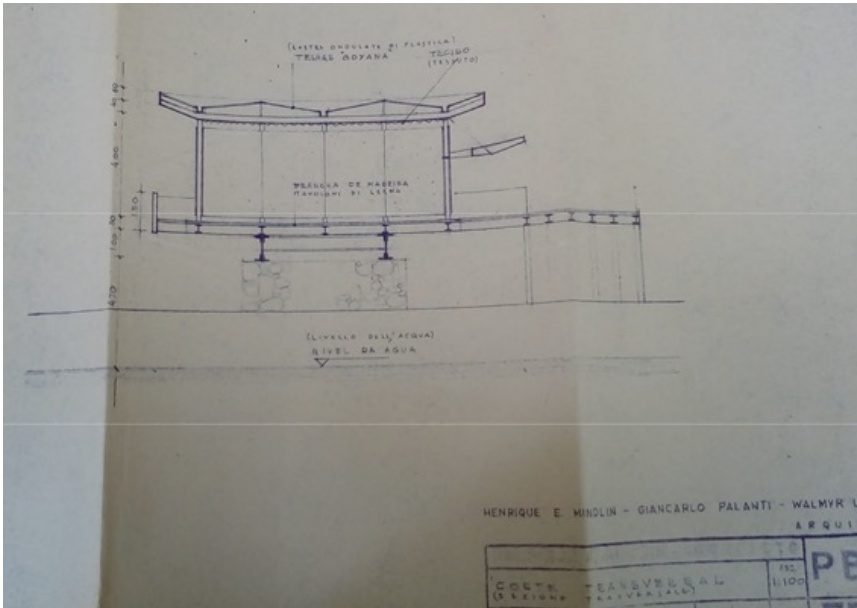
PROGETTO APPROVATO DALLA COMMISSIONE, 19 FEBBRAIO 1960.
